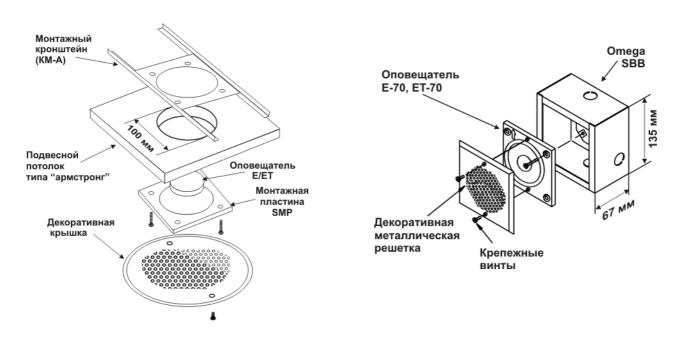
Габаритные размеры монтажной пластины SMP и размеры потолочных отверстий для установки оповещателей.
